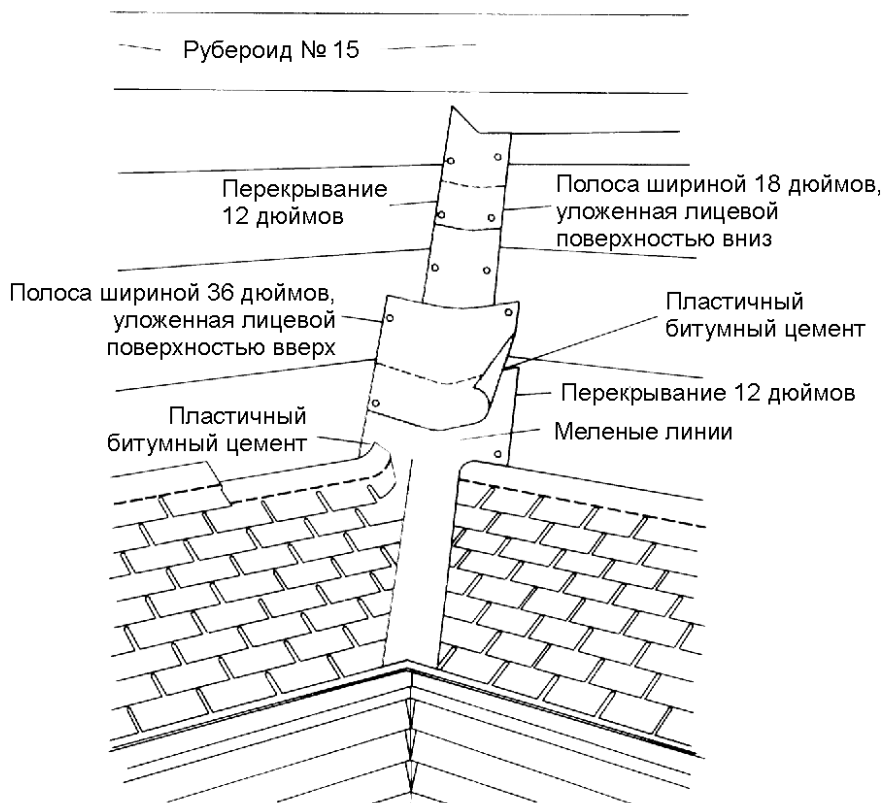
Использование рулонного кровельного материала для устройства гидроизоляции открытого разжелобка (Bird and Son)
